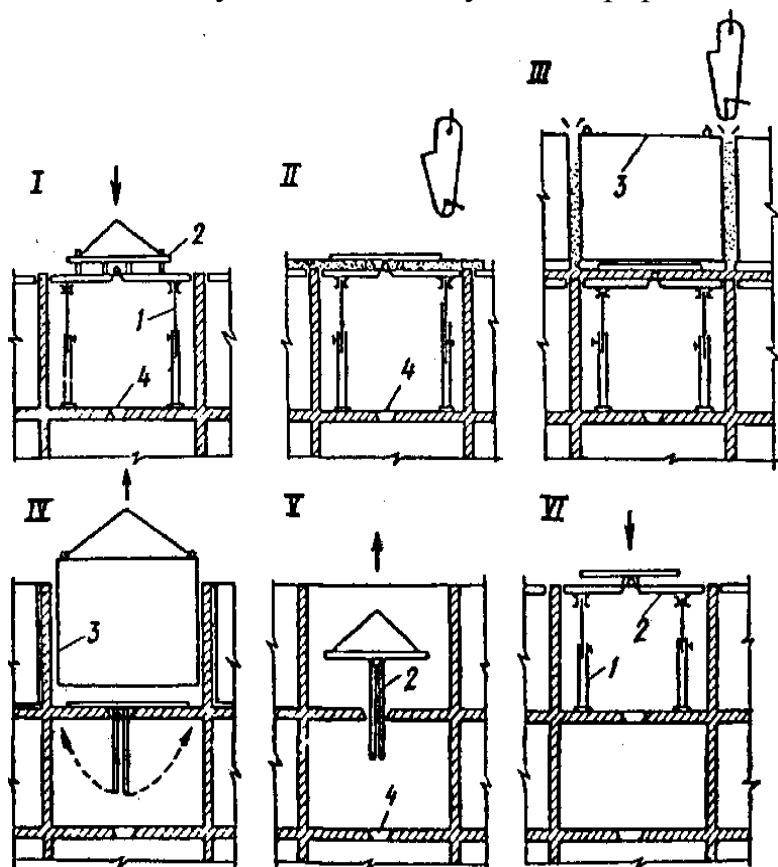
Технологічна схема зведення будівель у блочно-переставній опалубці з монолітним перекриттям:
